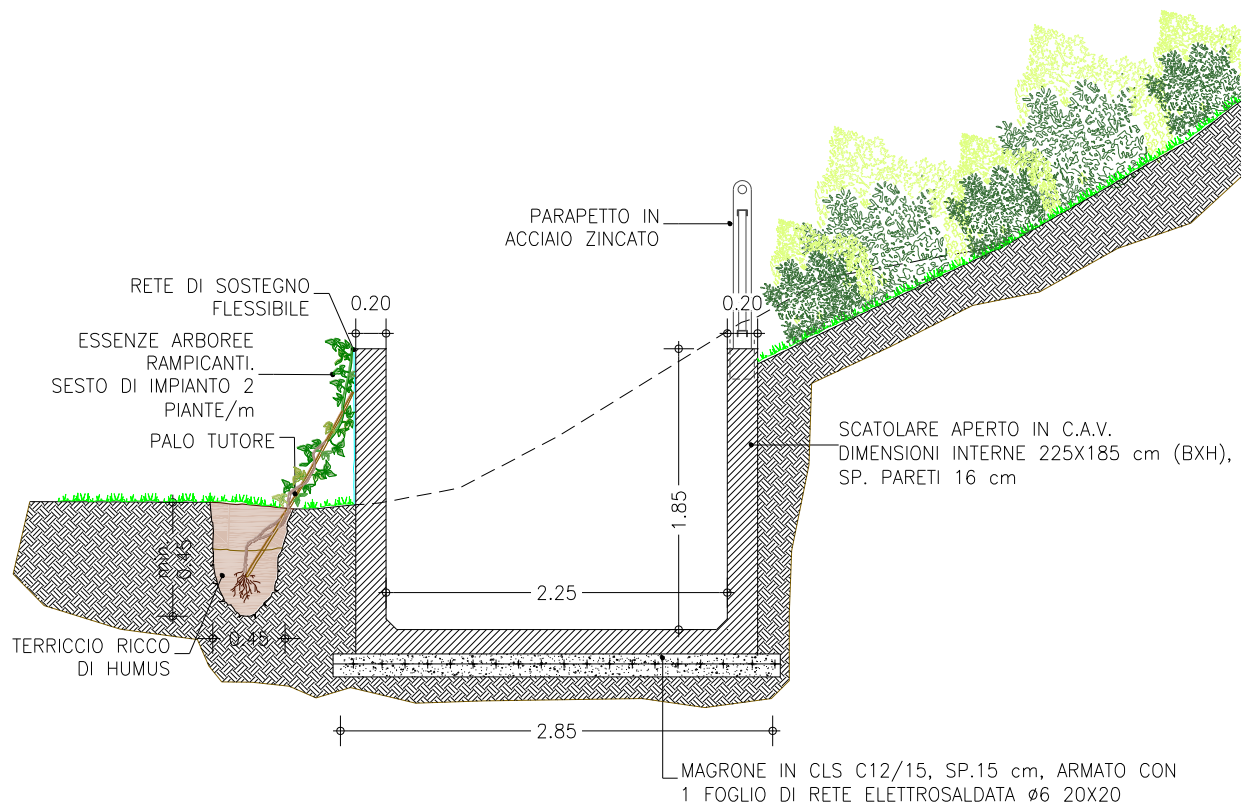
sezione scatolare aperta in c.a.v., nel tratto D-E del fosso ovest
